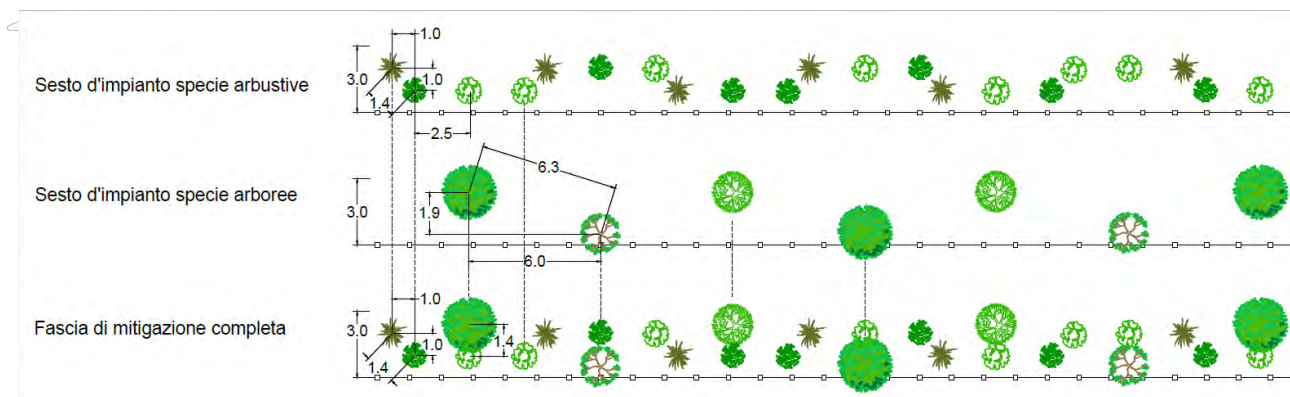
Dettaglio tipologico Fascia di mitigazione A – planimetria
